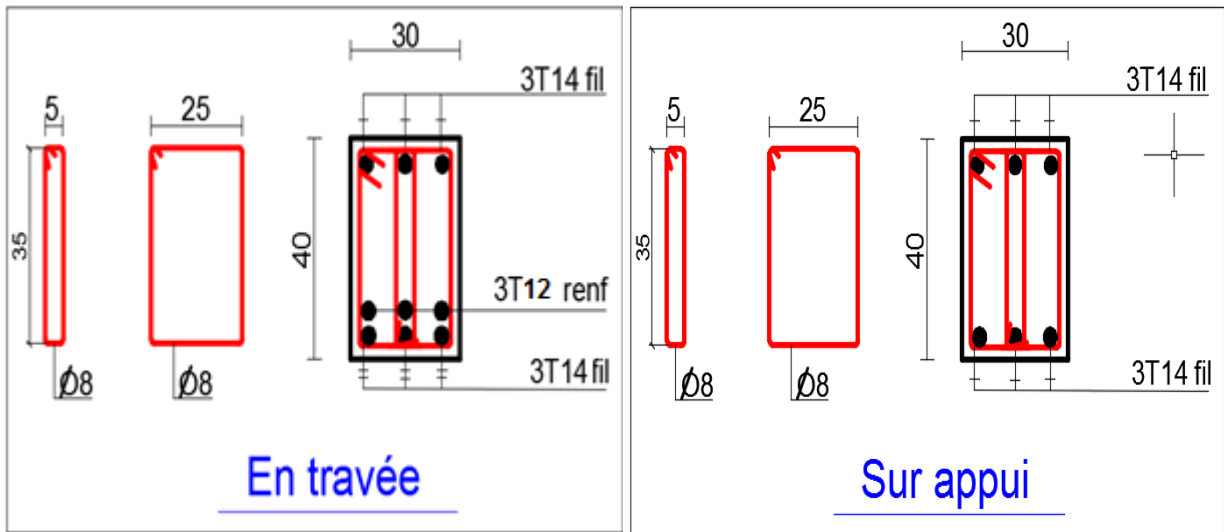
Schéma de ferrailage de la poutre palière.
